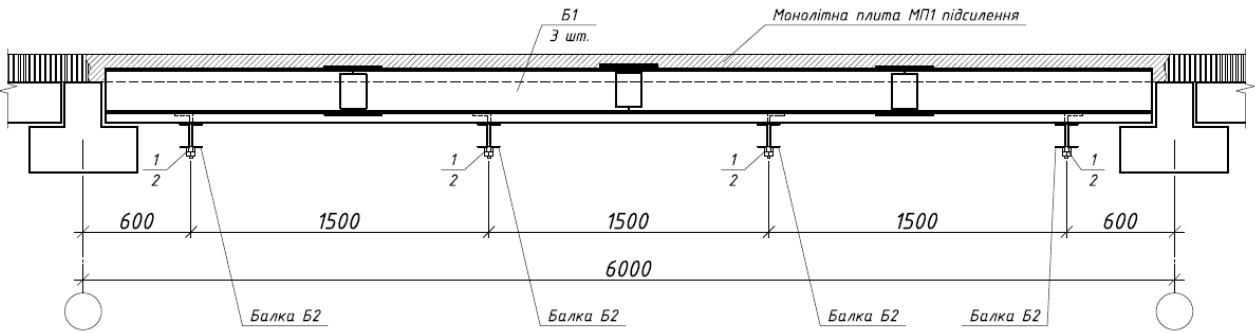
Схема підсилення конструкцій перекриття, повздовжній розріз.
